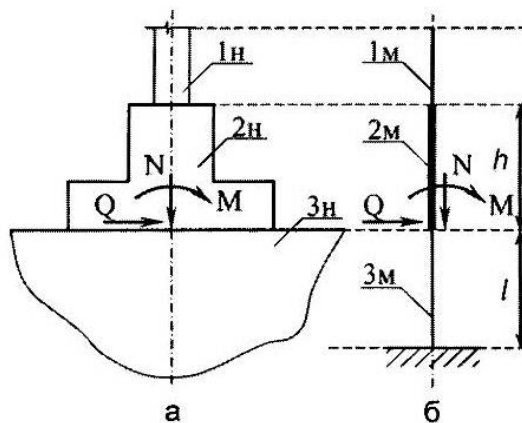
Принципова схема навантажень на фундаменти від горизонтальних деформацій земної поверхні ϵ
